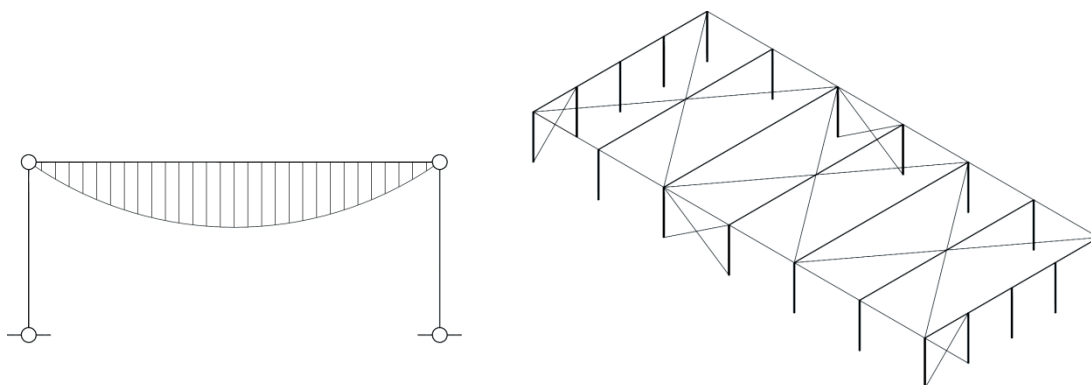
Diagrama de momentos de um pórtico de vigas simplesmente apoiadas e esquema 3D de um pavilhão característico com este tipo de pórticos (SECHALO, 2012)
